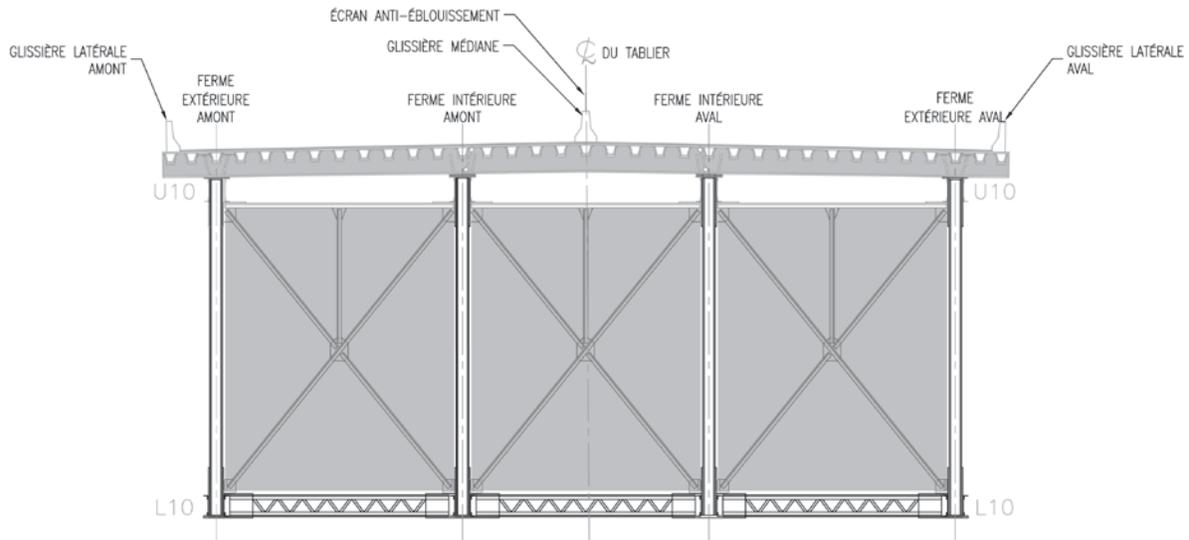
Coupe type travées 4W-2W/2E-4E – Section 6 (source : dessins nomenclature PJCCI)
